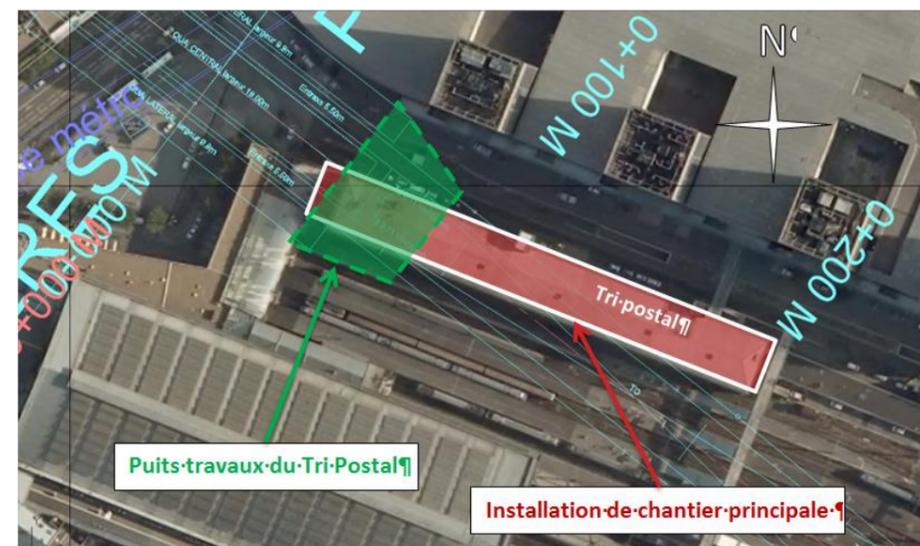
Implantation envisagée pour le puits principal de travaux et pour la base d'installation de chantier principale
